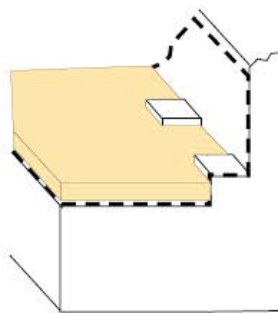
Principe d'un caniveau en pied de rampe inclinée
